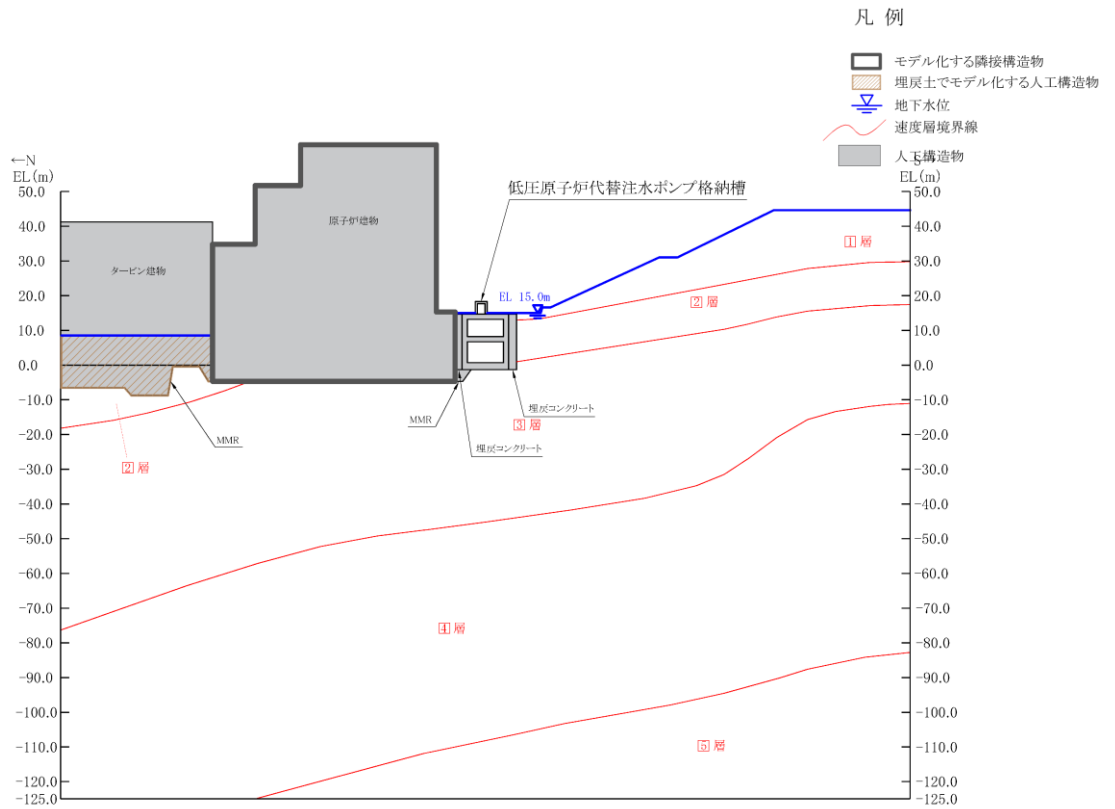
低圧原子炉代替注水ポンプ格納槽 評価対象断面図 (A-A 断面位置)
